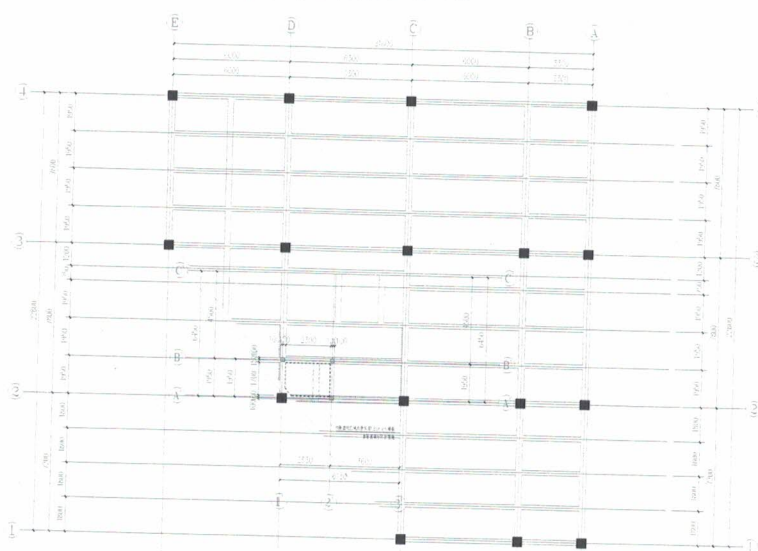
车库顶板剔除范围平面布置图(委托方提供)
